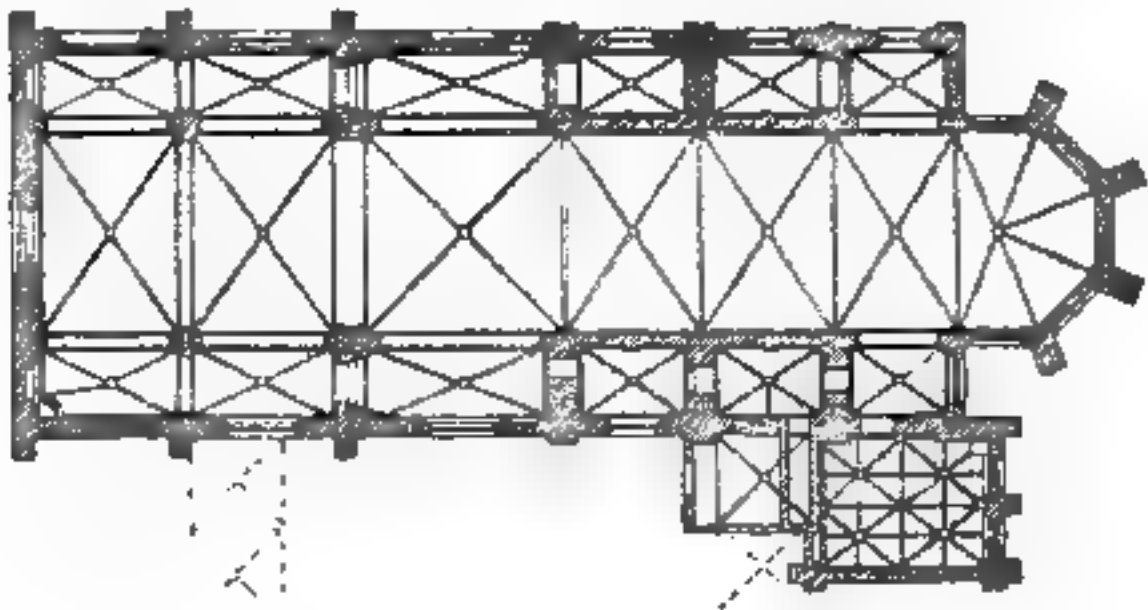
Grundriss der Kirche zu Bordesholm.
